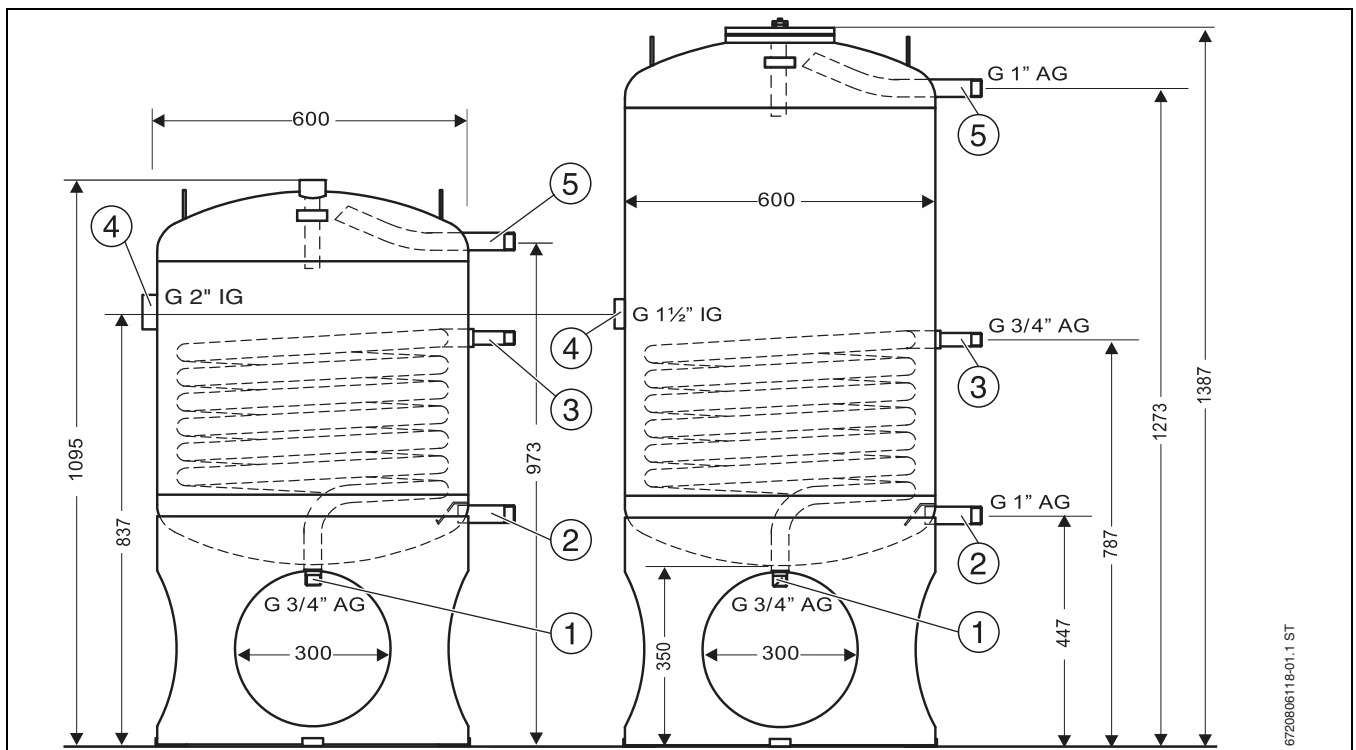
Acumulador solar Storacell Solar 160/250, dimensiones en mm
